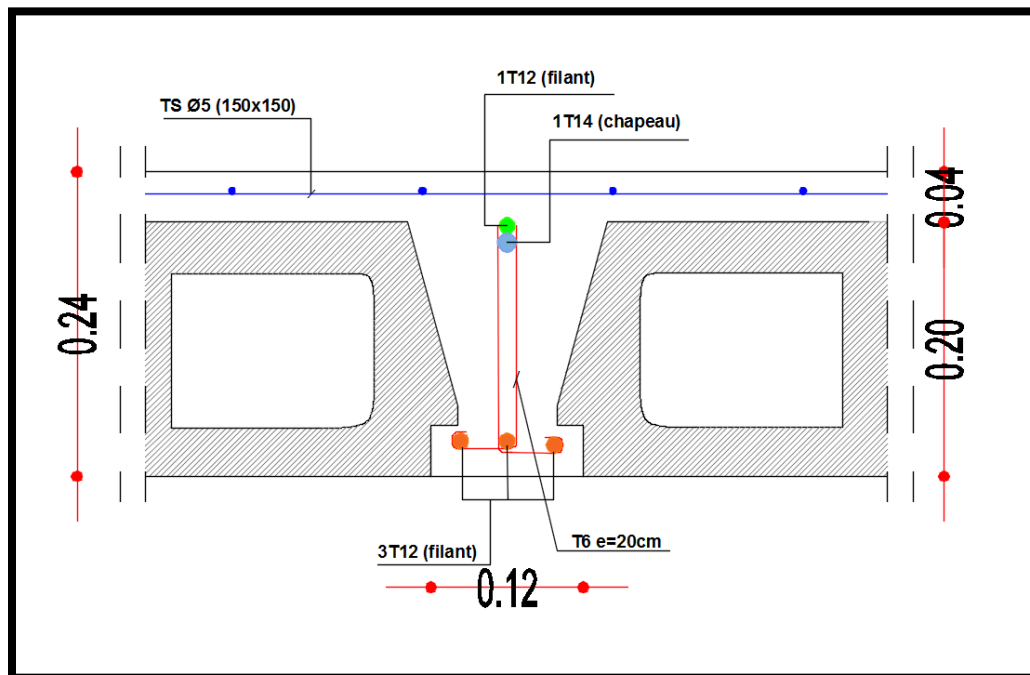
schéma de ferrailage de la poutrelle (terrasse)
